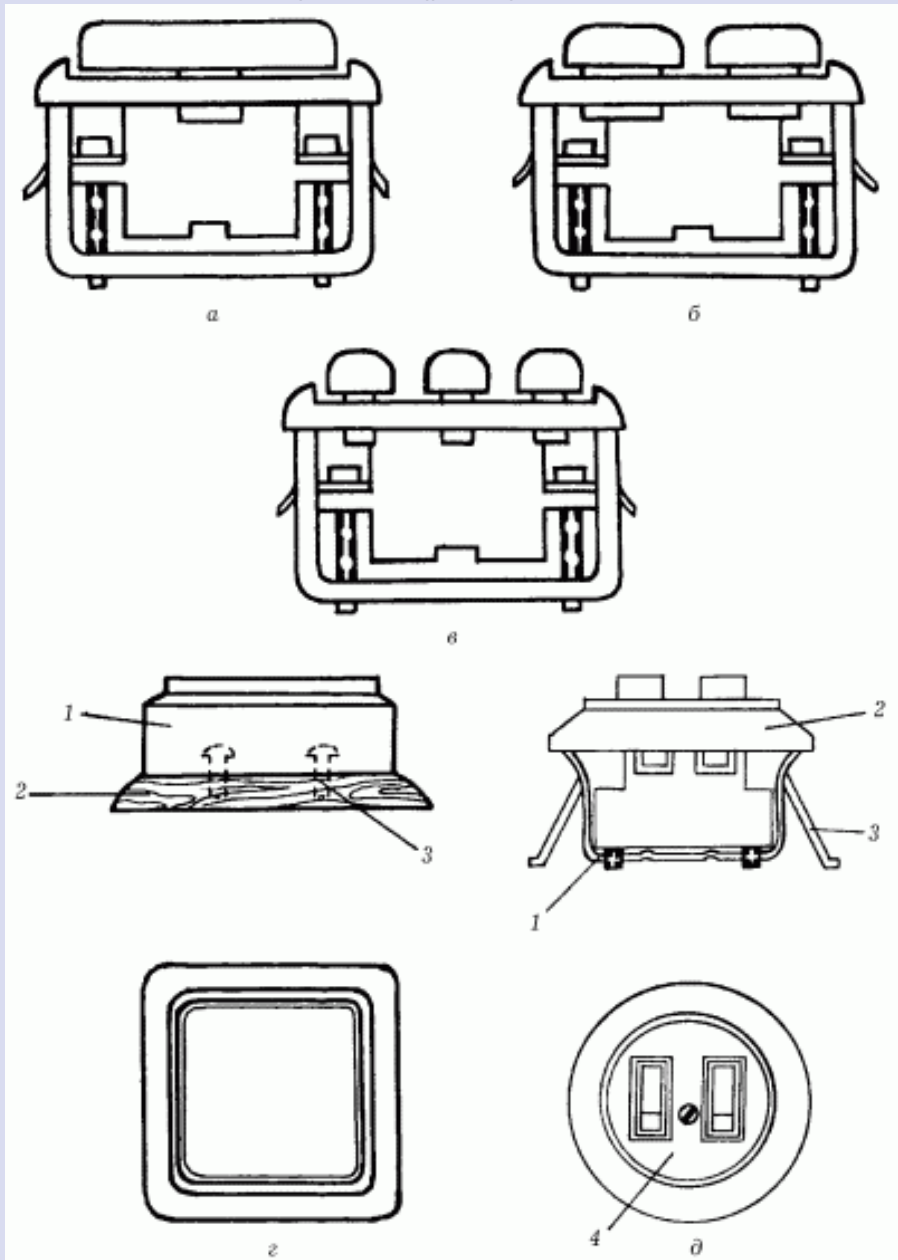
Типы выключателей: а – одноклавишный; б – сдвоенный; в – строенный; г – для открытой установки: 1 – корпус выключателя; 2 – подрозетник; 3 – шурупы; д – для скрытой установки: 1 – стальная или пластмассовая коробка; 2 – корпус выключателя; 3 – распорные лапки; 4 – винт.
